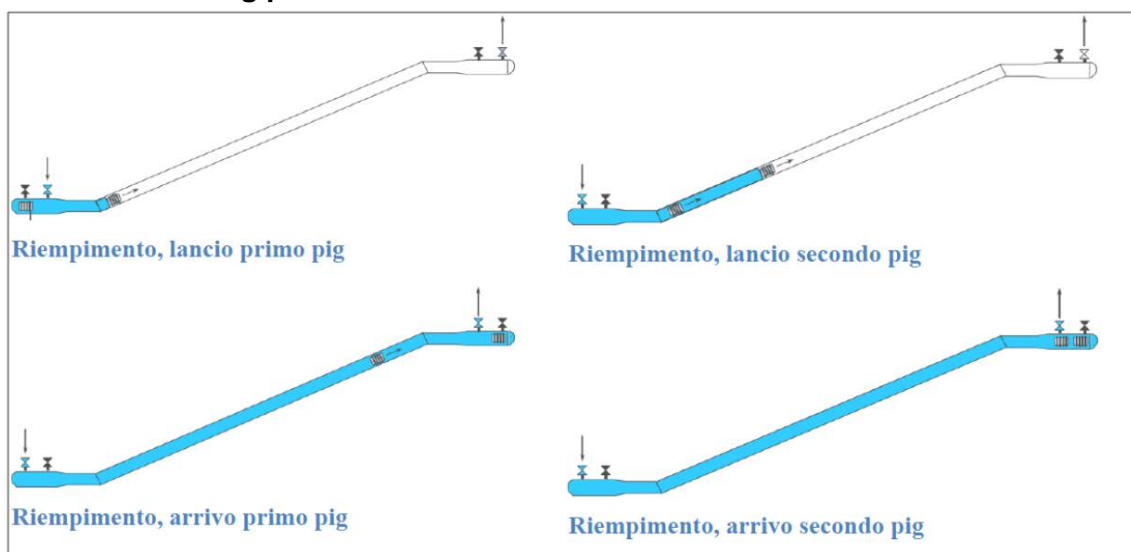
/A - Fase di riempimento del tronco di condotta sottoposto a collaudo
